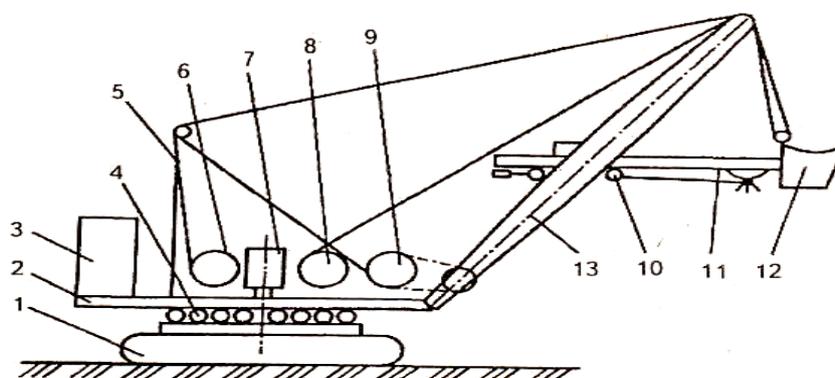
Одноковшовый самоходный экскаватор: 1 – ходовая часть; 2 – поворотная платформа; 3 – силовая установка; 4 – опорно-поворотное устройство; 5 – стойка; 6 – стрелоподъемный механизм; 7 – канатный барабан; 8 – подъемный механизм; 9 – напорный механизм; 10 – канатный механизм; 11 – рукоять; 12 – ковш; 13 – стрела
